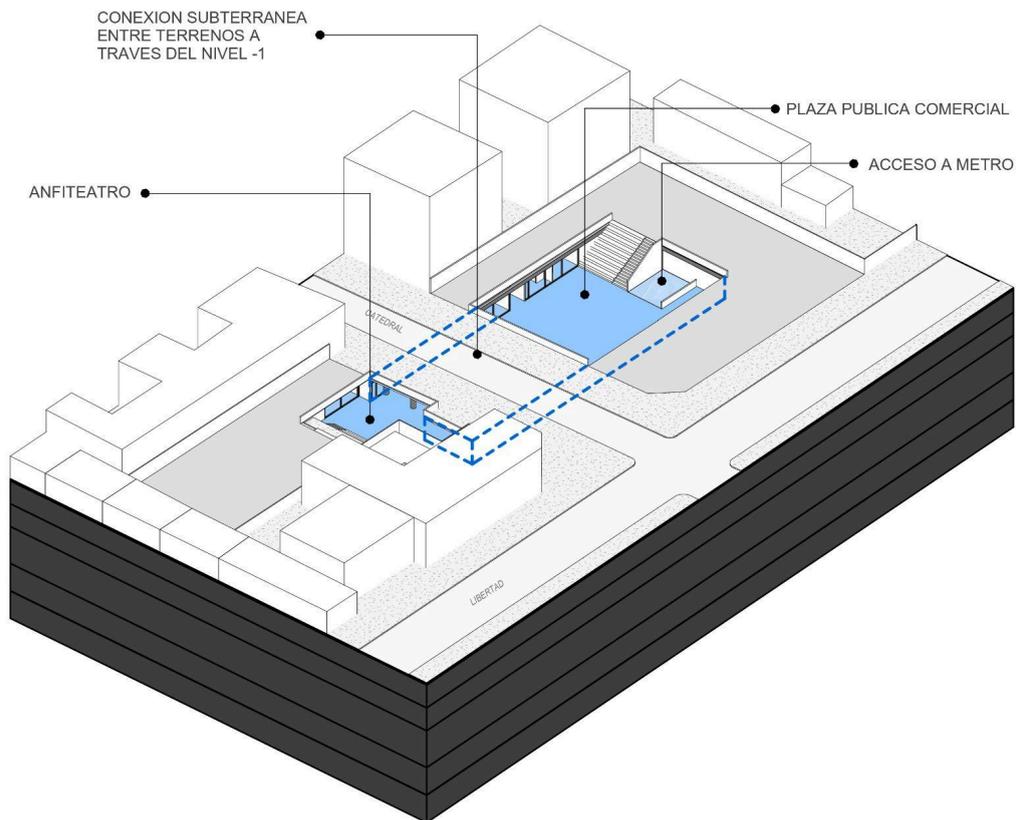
Esquema de conexión subterránea entre terrenos. Fuente: Elaboración propia.
